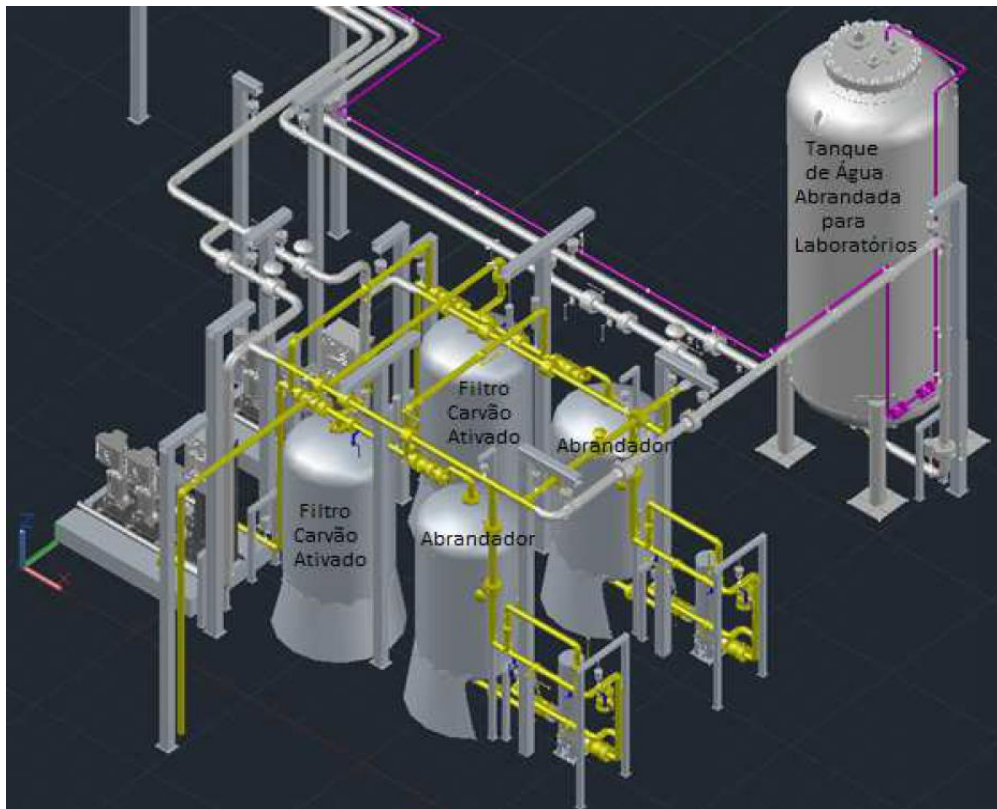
Layout orientativo 3D da planta de fabricação de água abrandada para o circuito C6 que será instalada dentro da casa de bombas 1.
